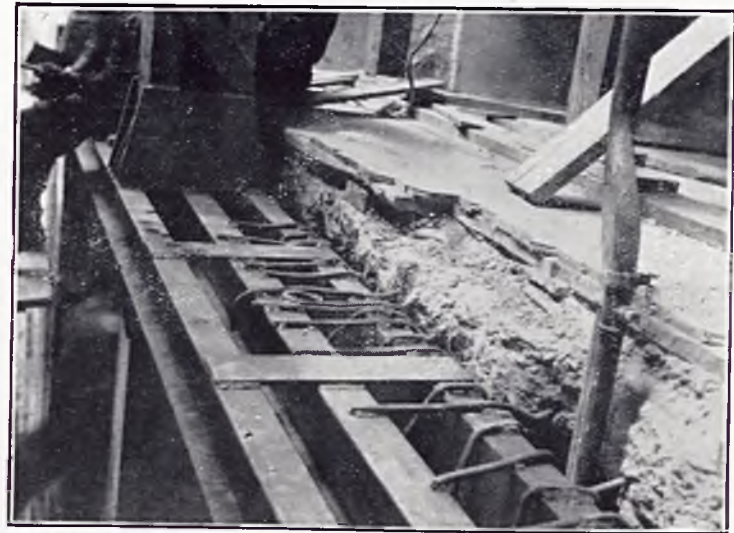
Jonction de l'ancien bâtiment en béton armé avec la construction soudée.
